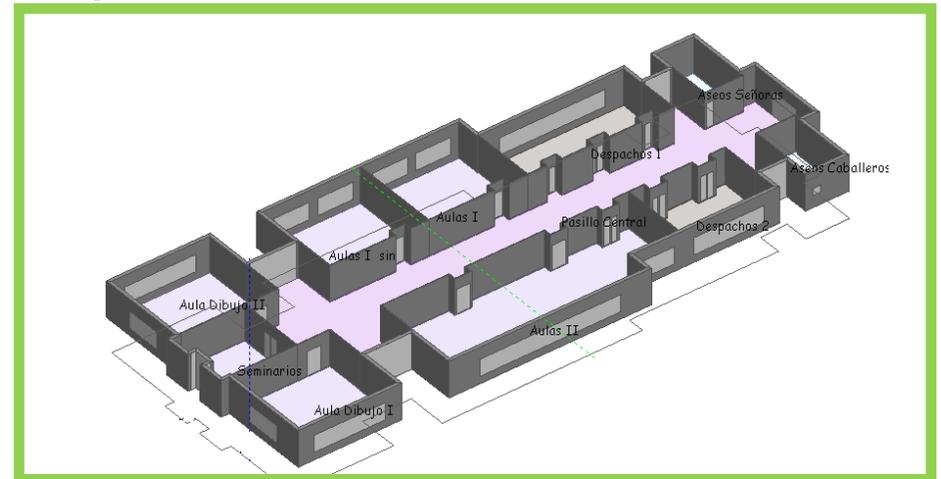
Planta 2 del Pabellón de Arquitectura Técnica.
